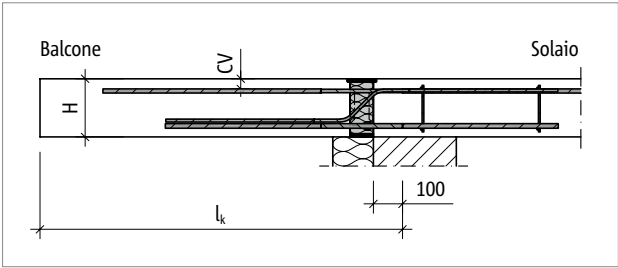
Schöck Isokorb® T tipo KP-M13 – M14: sistema statico
